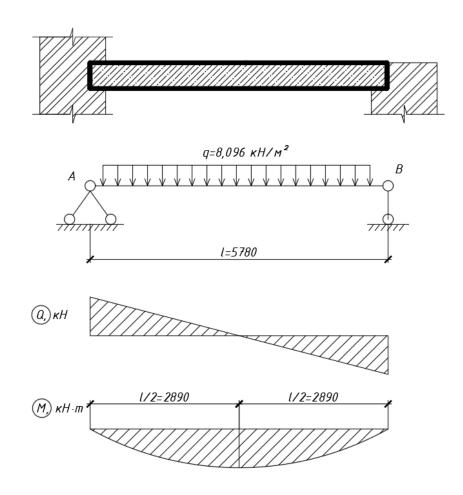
Расчетная схема плиты покрытия ПМ1
